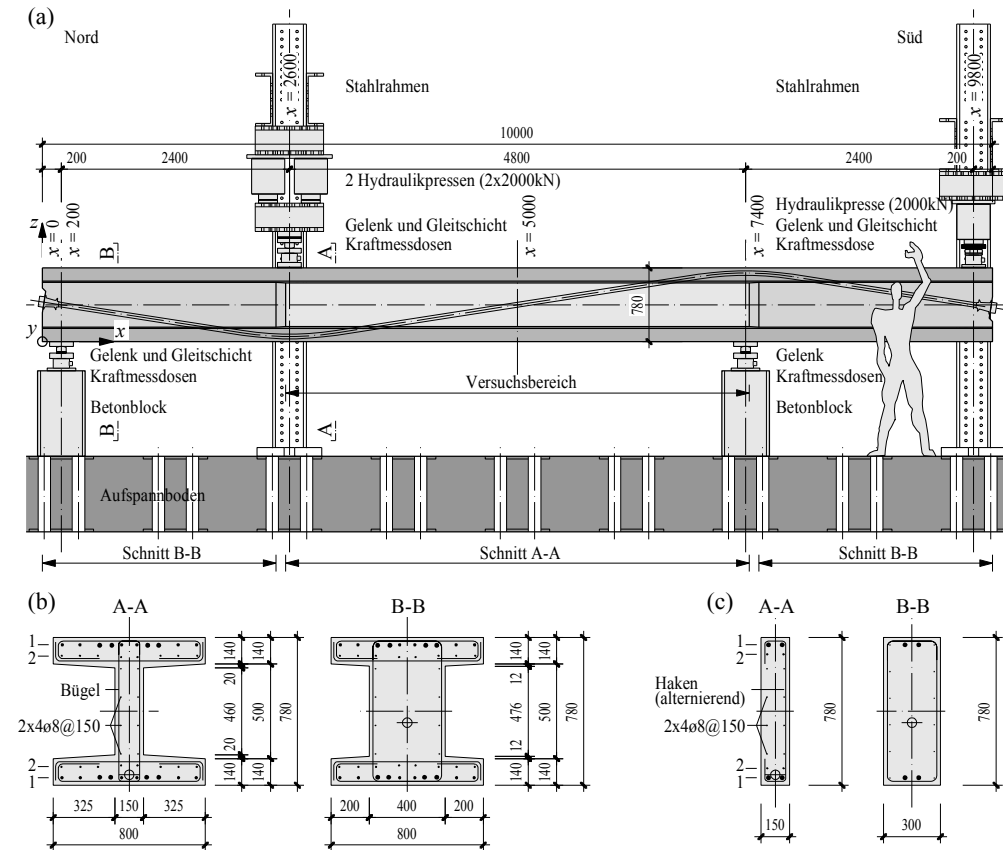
Versuchsaufbau, Trägerabmessungen und Bewehrung (Masse in [mm], Querkraftbewehrung und Bewehrung Layer 1 und 2 in Abbildung 3.1): (a) Längsansicht des Versuchsaufbaus; (b) Abmessungen und Bewehrung der Träger mit Flanschen; und (c) Abmessungen und Bewehrung der Träger ohne Flansche.
